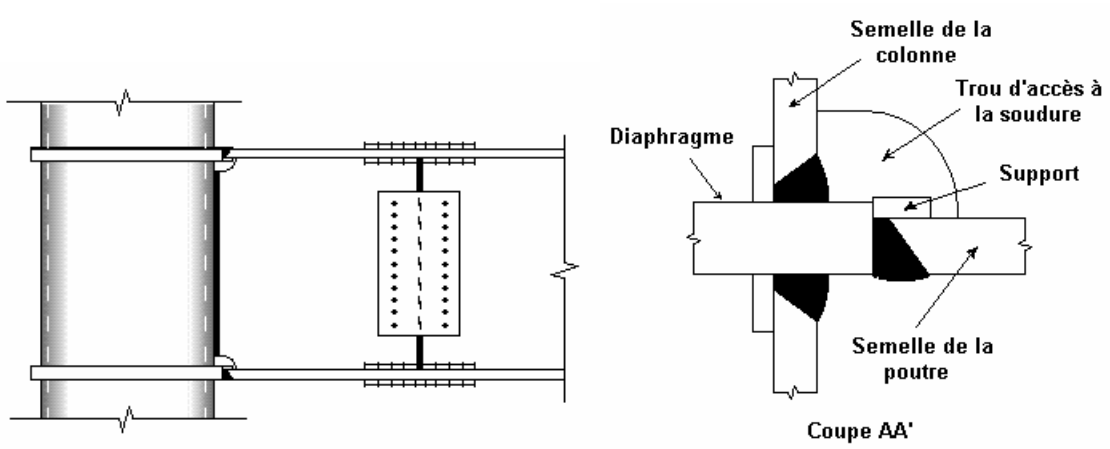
Assemblage poutre-poteau réalisé en atelier
